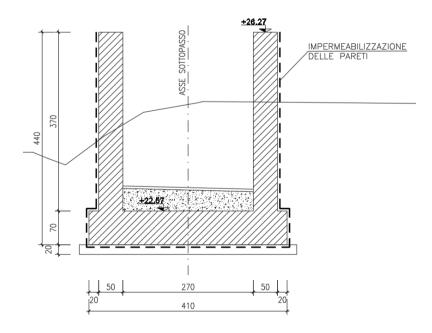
Sezione di calcolo 1 muri di imbocco SL23
